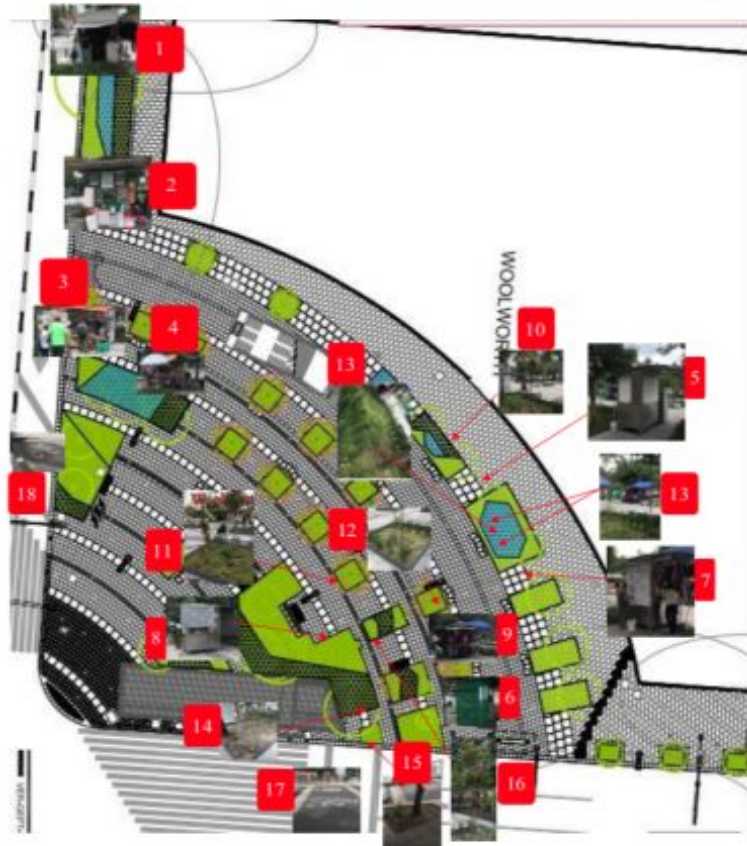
Proyecto AS BUILT Plano con reporte fotográfico, indicado a aspectos observados en la visita.
